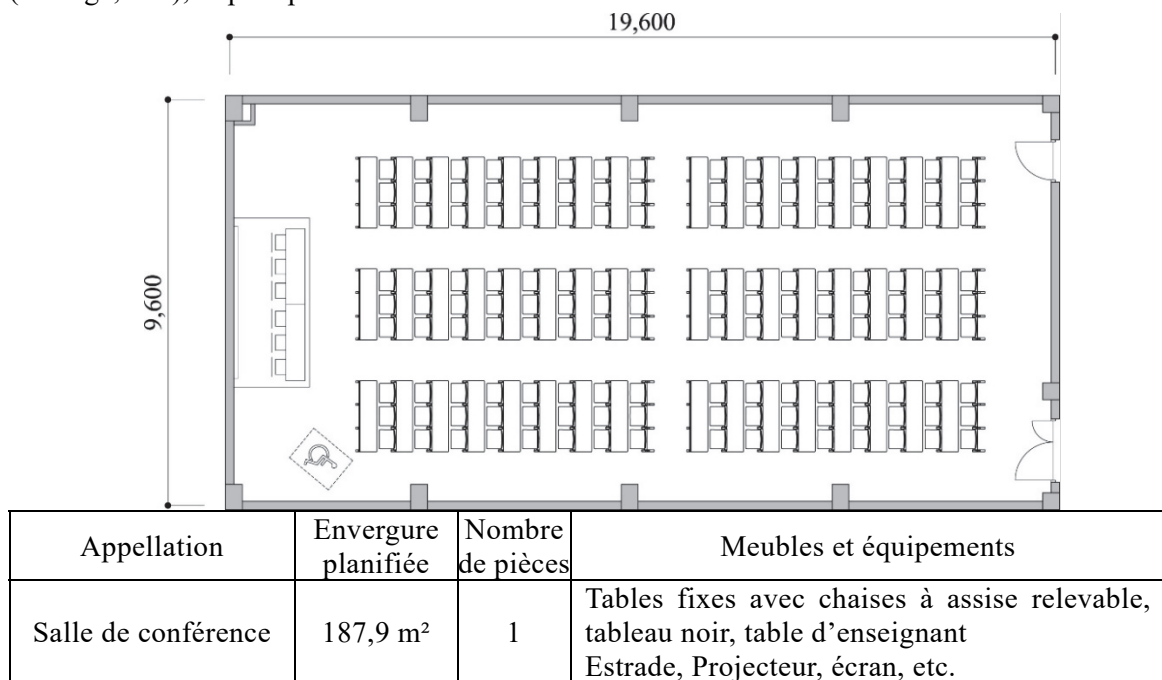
Plan au sol de la salle de conférence, et contenu du plan
